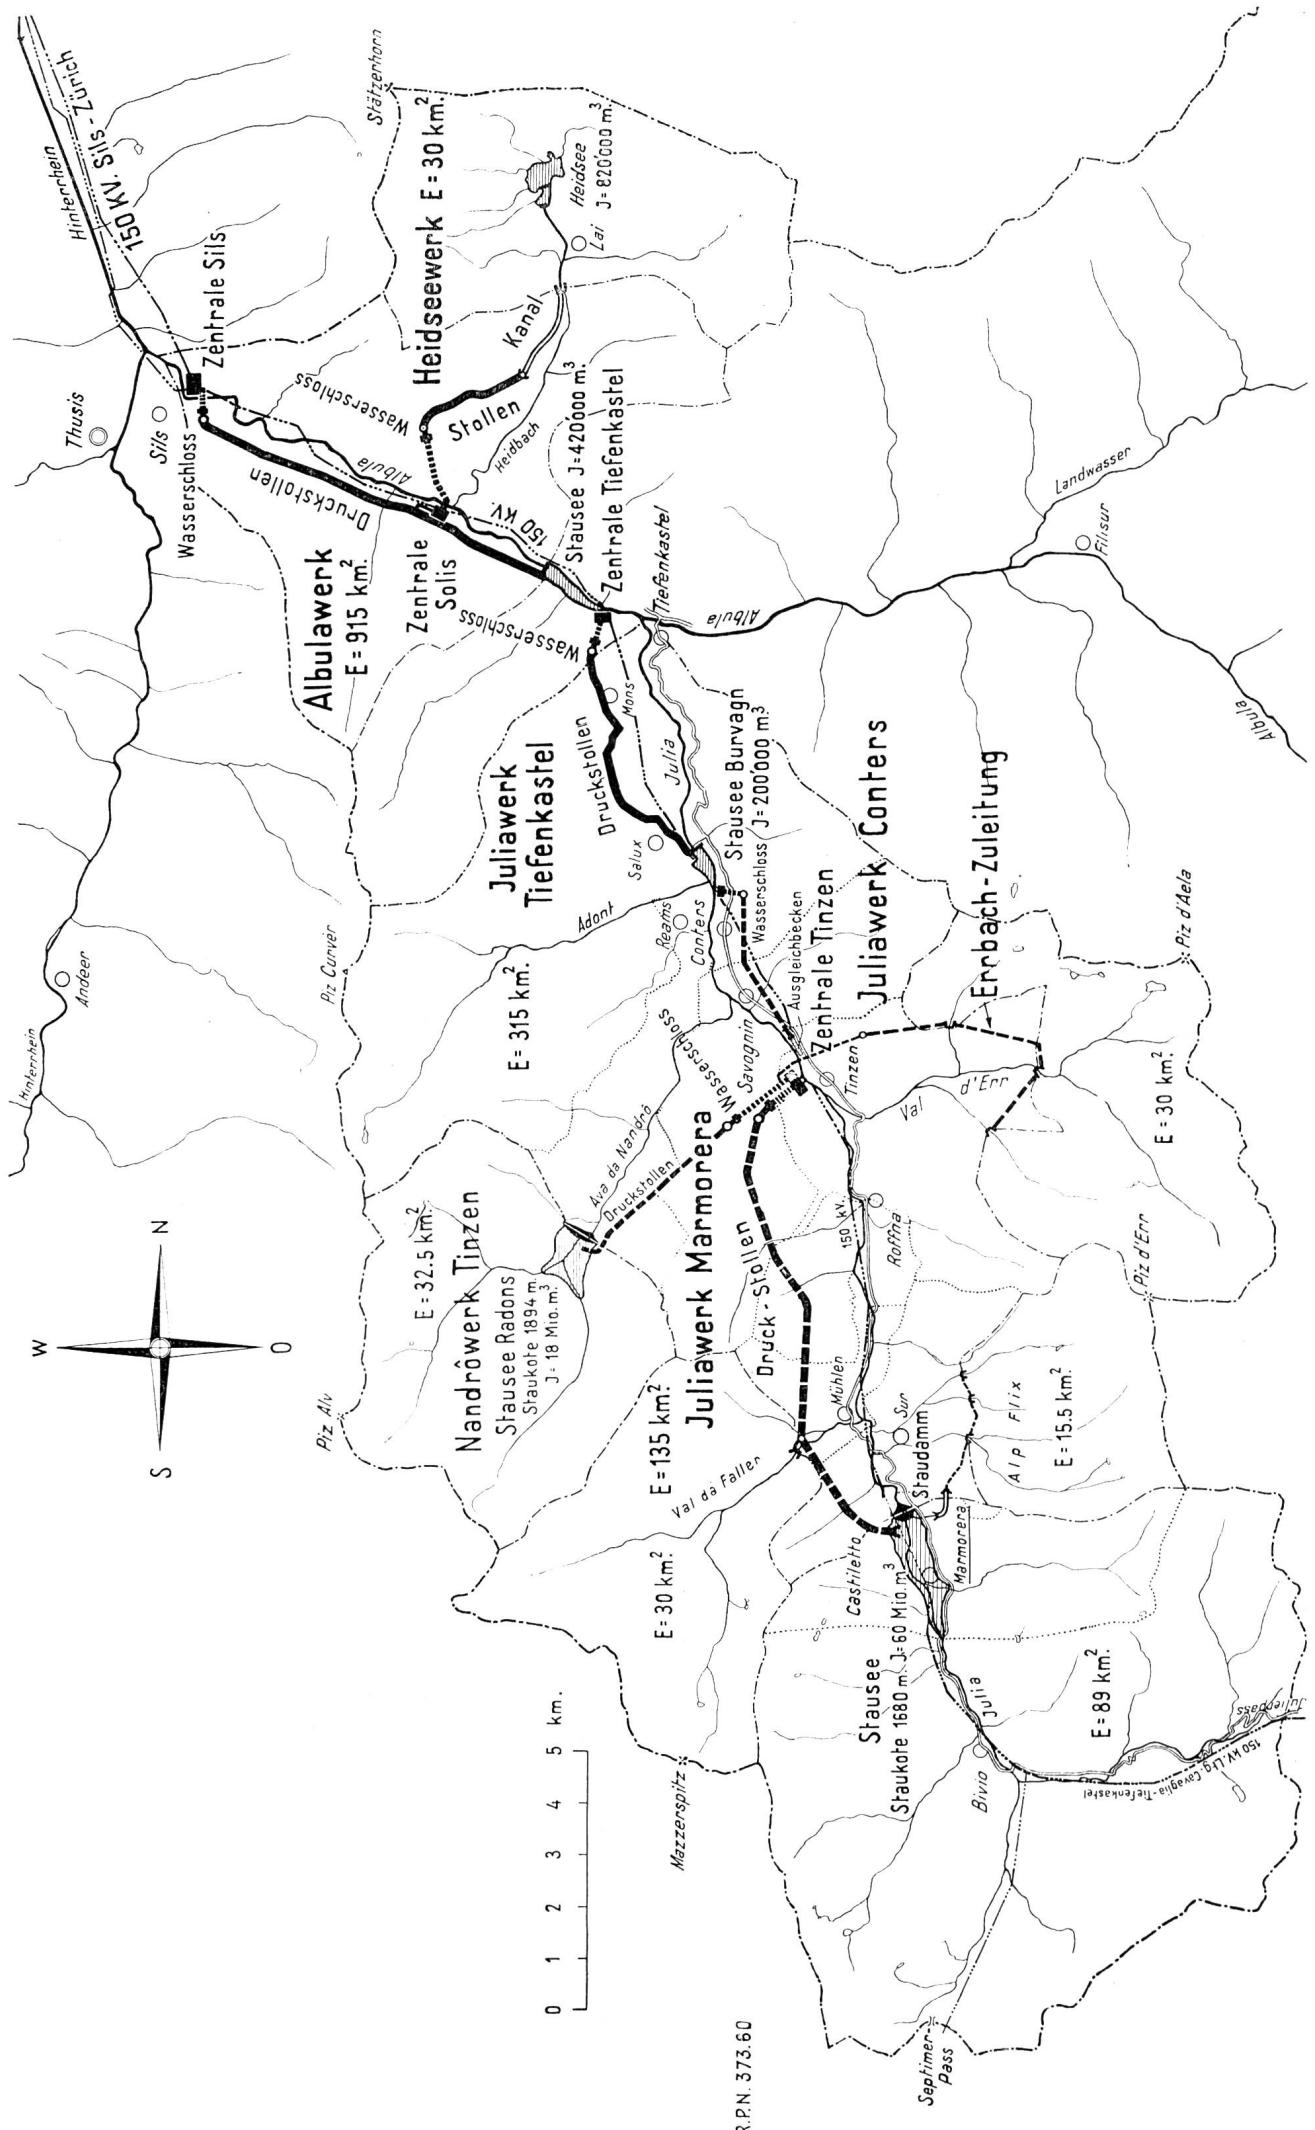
Lageplan der Kraftwerkgruppe Graubünden der Stadt Zürich
